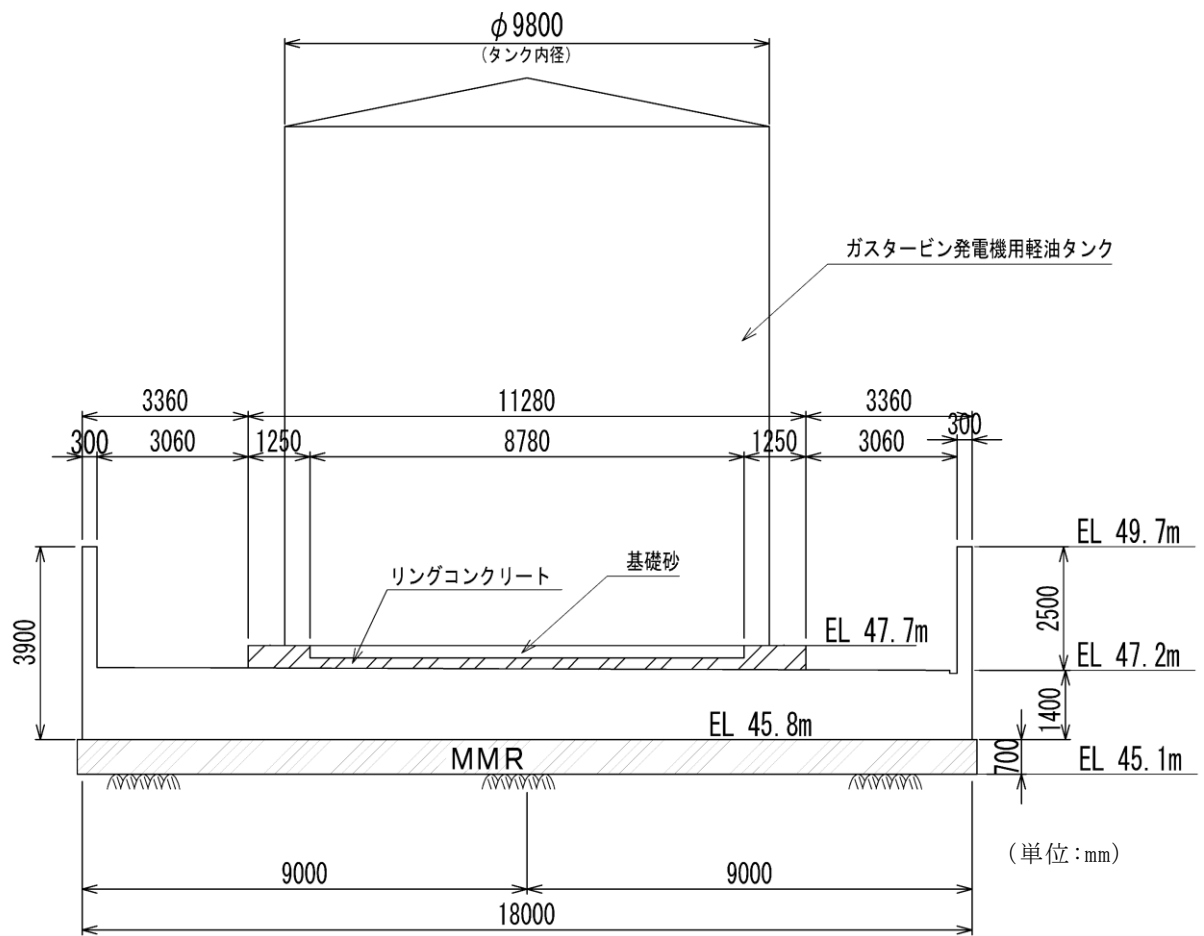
ガスタービン発電機用軽油タンク基礎 断面図 (A-A 断面及び B-B 断面)
